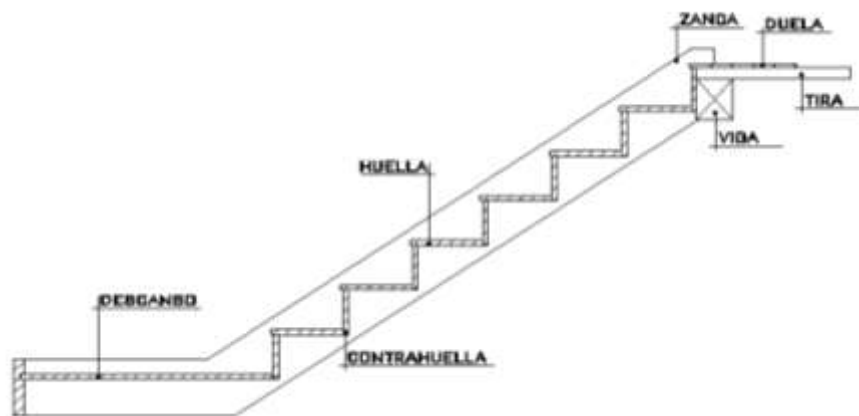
Detalle constructivo – Corte longitudinal de escalera tipo
